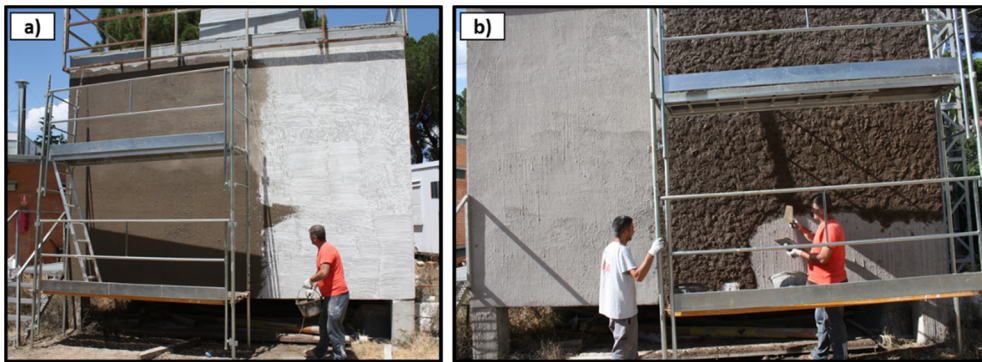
(a) Aplicación de la primera capa de mortero. (b) Enfoscado de la fachada
